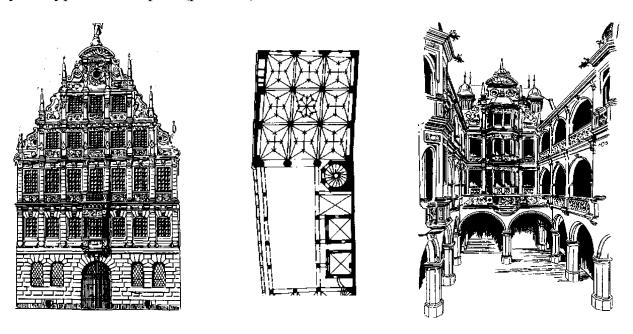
Нюрнберг, Дом Пеллера (1592). Фасад. План. Внутренний двор
